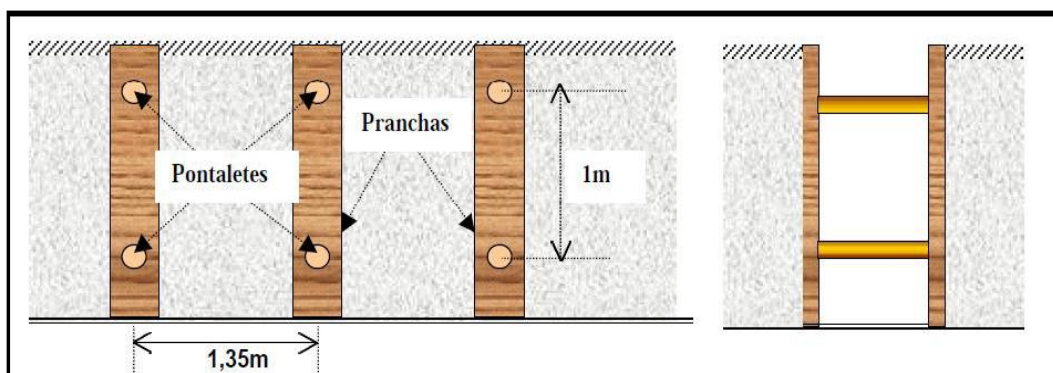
Pontaleteamento (corte longitudinal e transversal)
